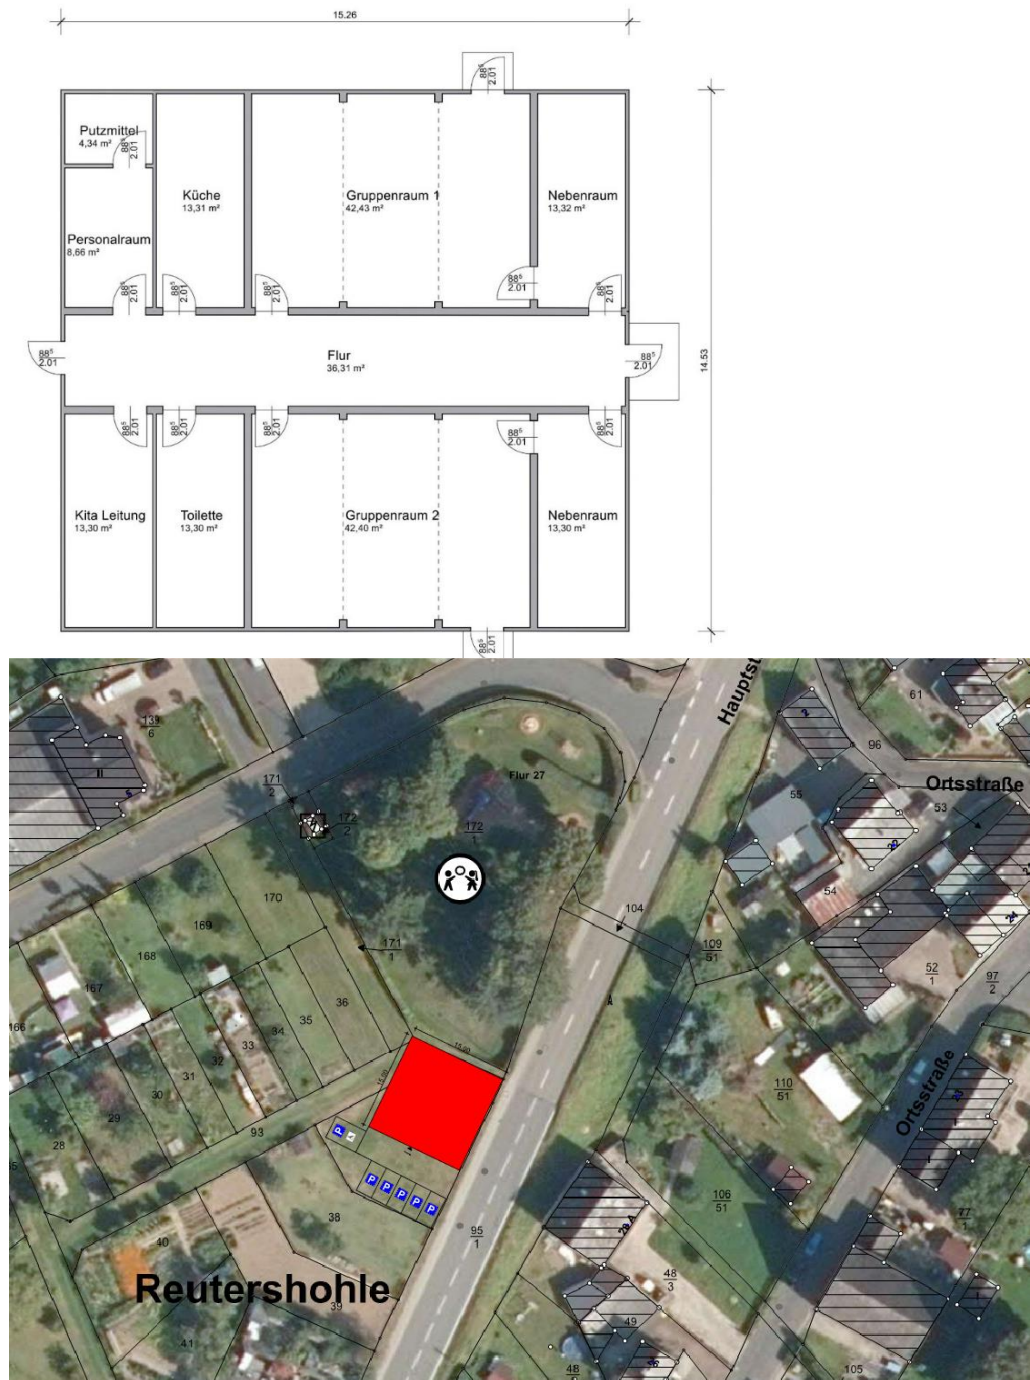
Grundriss des Containers sowie Lageplan für die Kindertagesstätte
